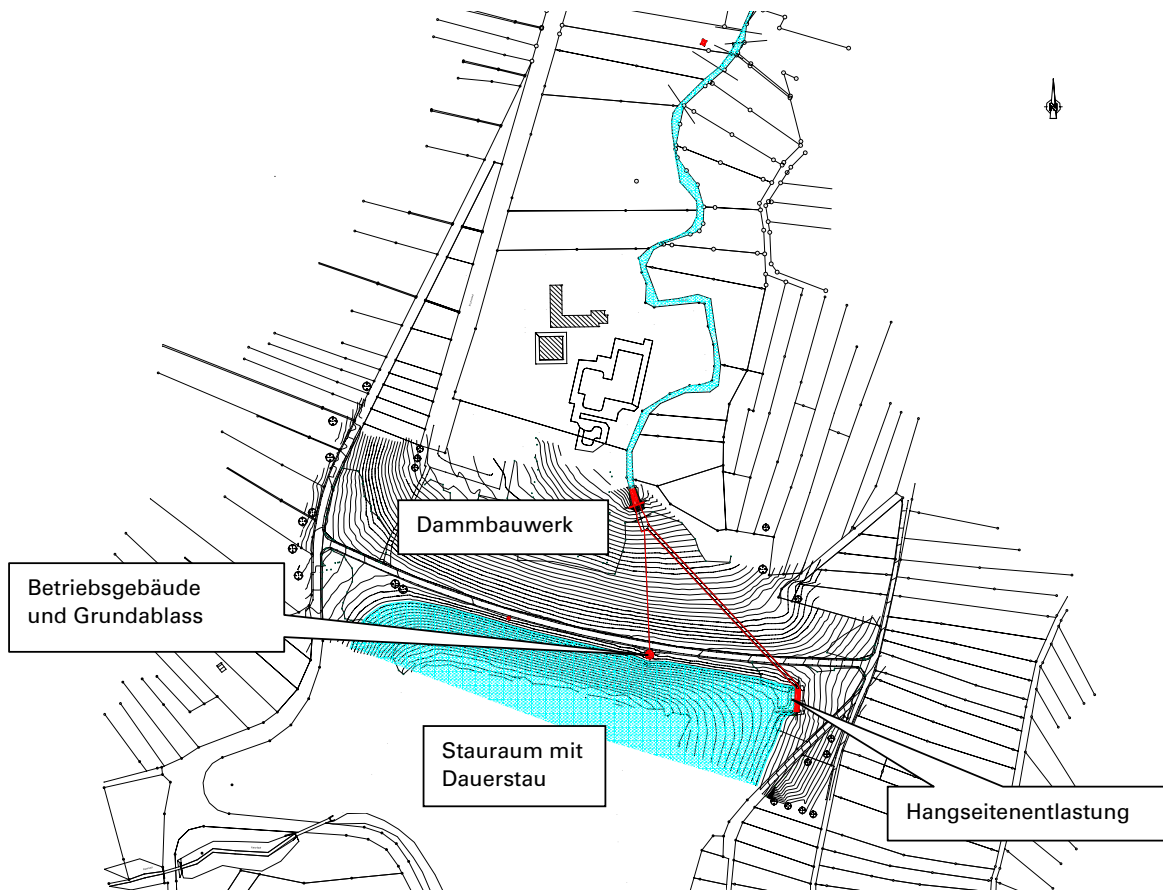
Lageplan Hochwasserentlastungsanlage
